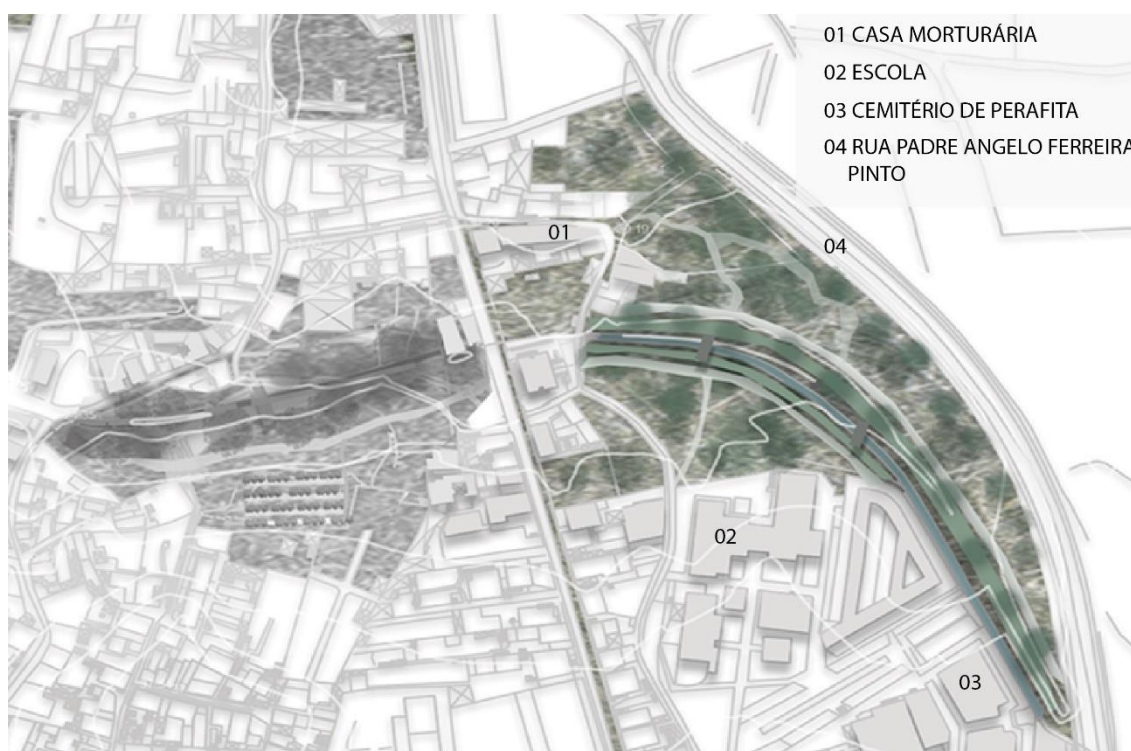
Ribeira Joane- Plano conceptual- troço 7 (fonte: autor)
